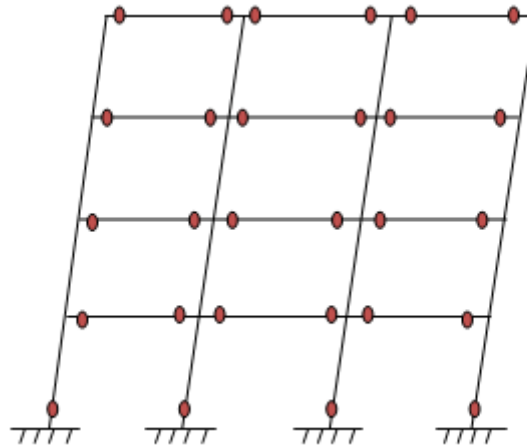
rotules plastiques dans les poutres et en pied des poteaux du RDC
